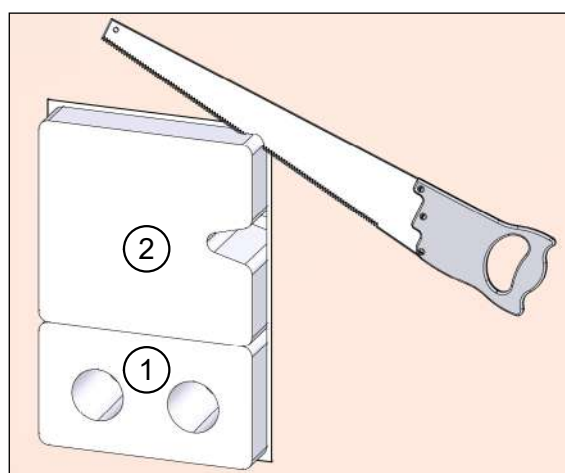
Modifica della cassetta a muro con elemento di riempimento
